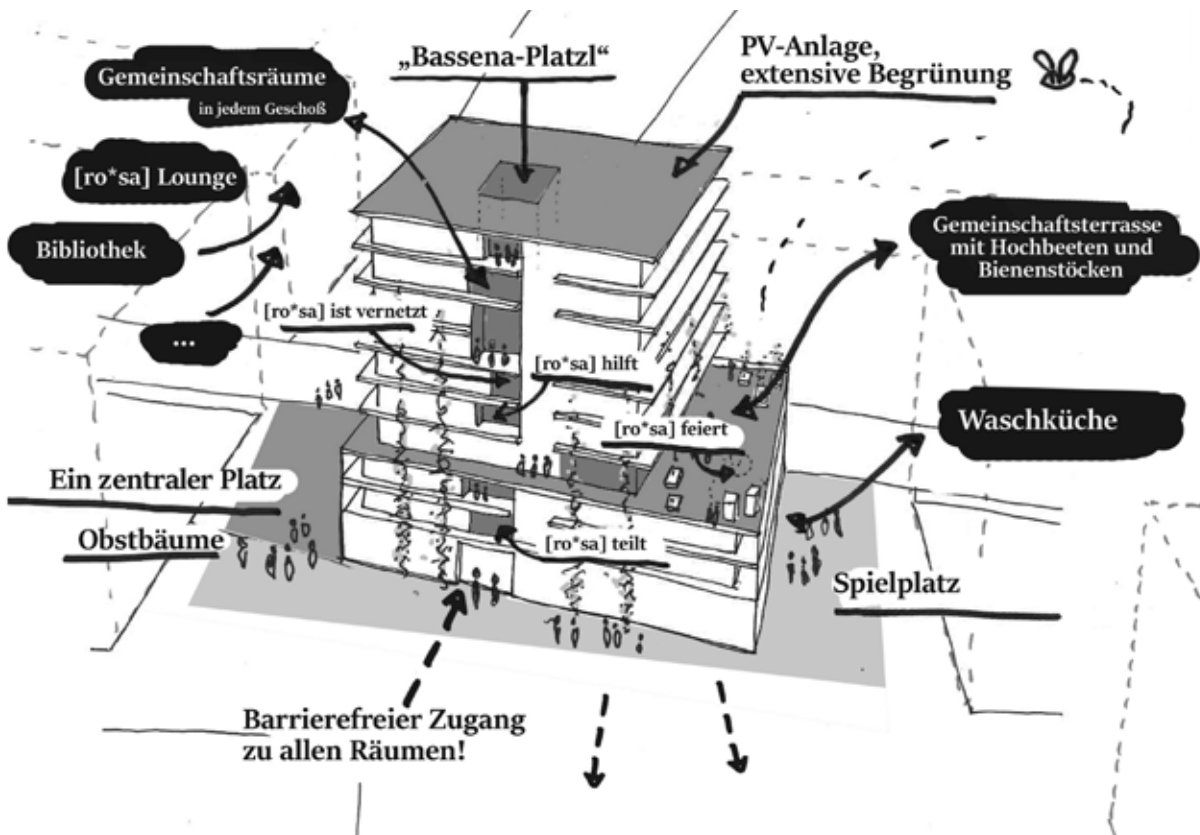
Soziale Infrastruktur, [ro*sa] Chance, Bauträgerwettbewerb An der Schanze
